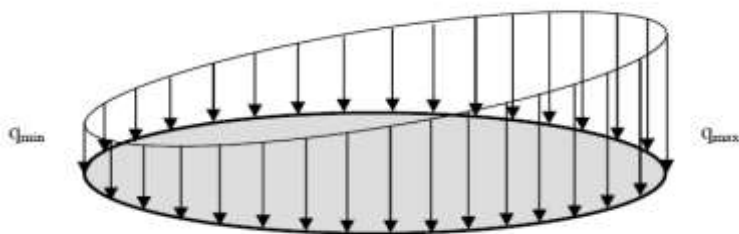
Нагрузки на фундаментное кольцо резервуара.
